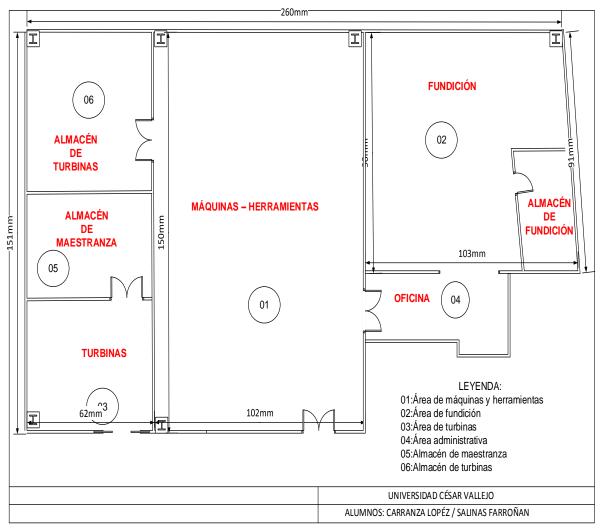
Layout de planta actual de la empresa G&M S.A.C.
